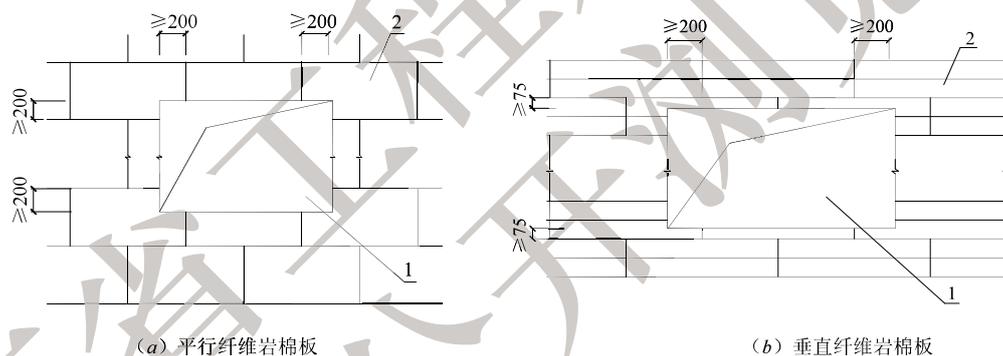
门窗洞口排板示意（尺寸单位：mm）
